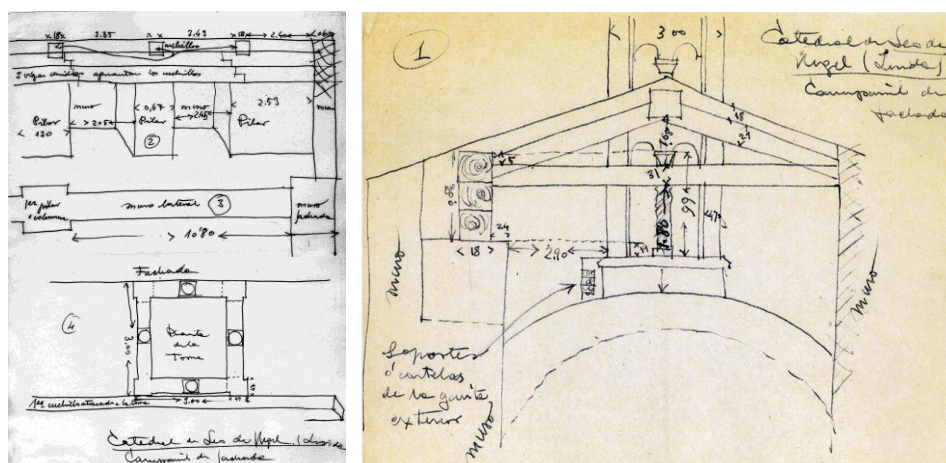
Seo de Urgel. Catedral de Santa María AAFV. Croquis de la planta y sección del campanil de fachada
